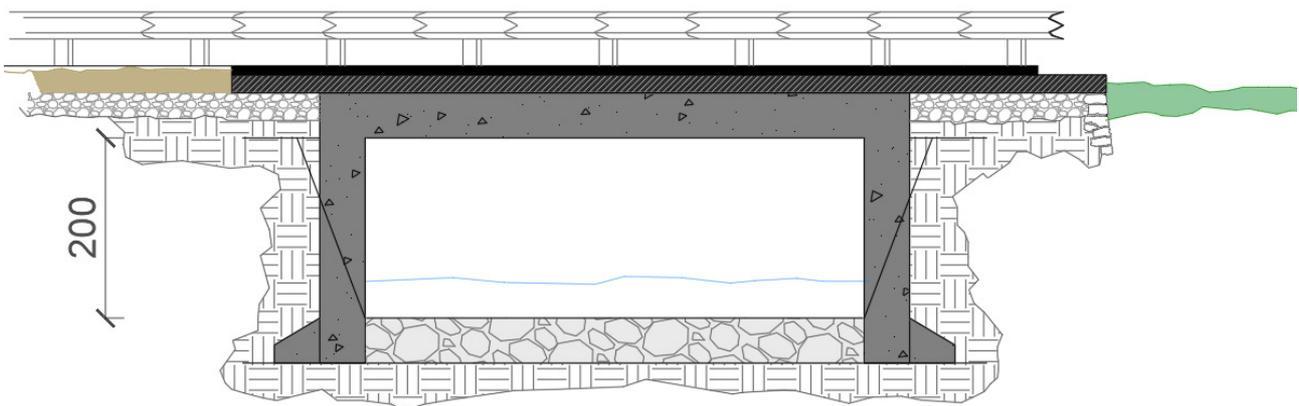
Sezione di progetto dell'attraversamento della SR45
